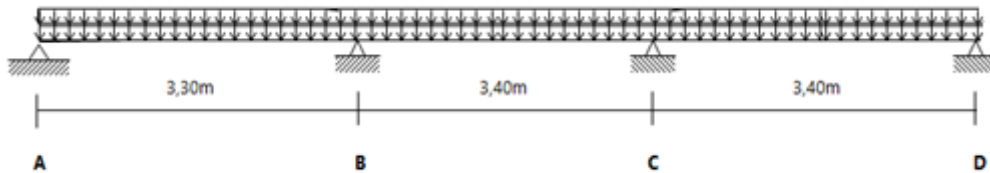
Schéma statique de la poutrelle à trois travées
